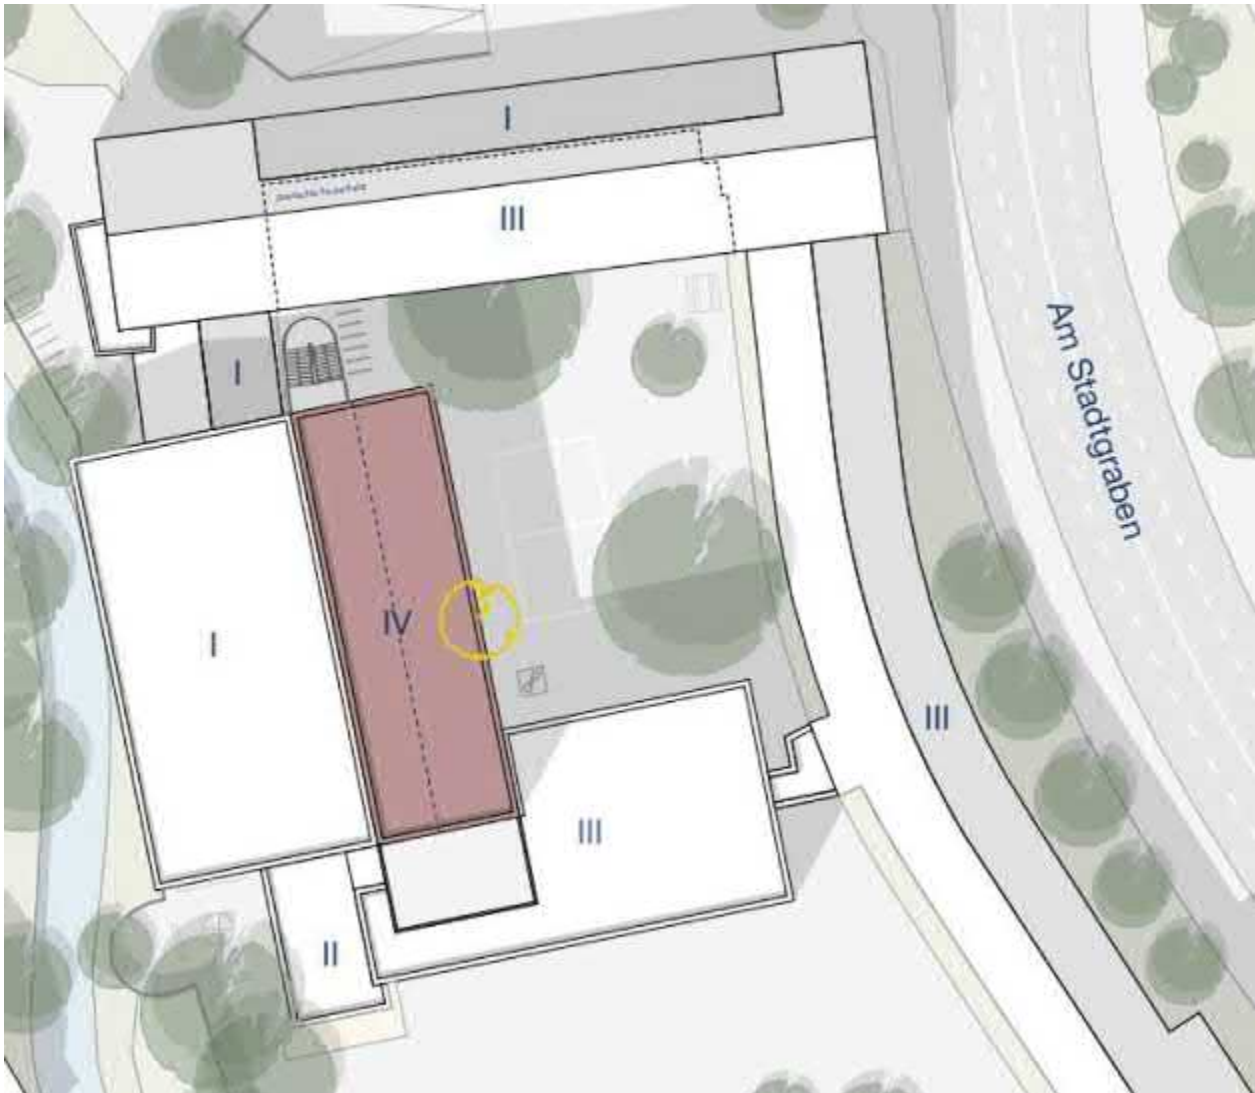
Lageplan nach Erweiterung - Stand 06.03.2024 – [REDACTED]
